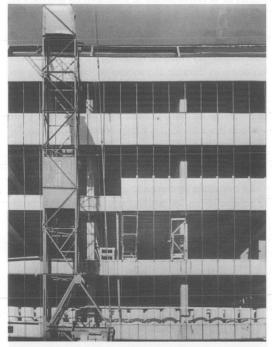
Montaje del cerramiento formado por el panel prefabricado con acabado cerámico en el Edificio Porthania, 1950-1957 (Johansson, Lahti y Paatero 2010)
